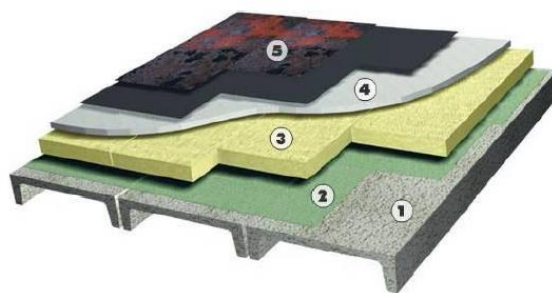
Структура плоской кровли: 1 – плиты покрытия; 2 – слой пароизоляции; 3 – слой утеплителя; 4 – железобетонная стяжка; 5 – слой гидроизоляции (рулонной или наплавляемой)
